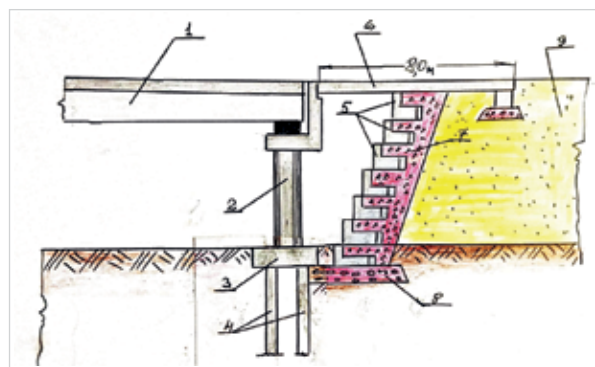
Продольный разрез путепровода с устоями с раздельными функциями в виде подпорной стены из пустотелых железобетонных блоков, заполненных щебнем: 1. пролетное строение; 2. столбчатая опора устоя; 3. ростверк; 4. забивные сваи; 5. пустотелые железобетонные блоки; 6. переходная плита; 7. щебень; 8. матрацы Рено; 9. подходная насыпь
